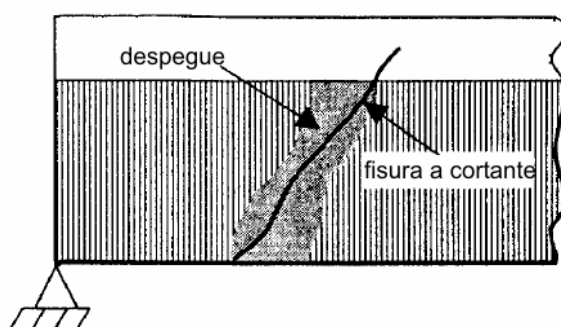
Refuerzo continuo por fallo en zona próxima a fisura, por despegue, inicialmente local y posteriormente general.
